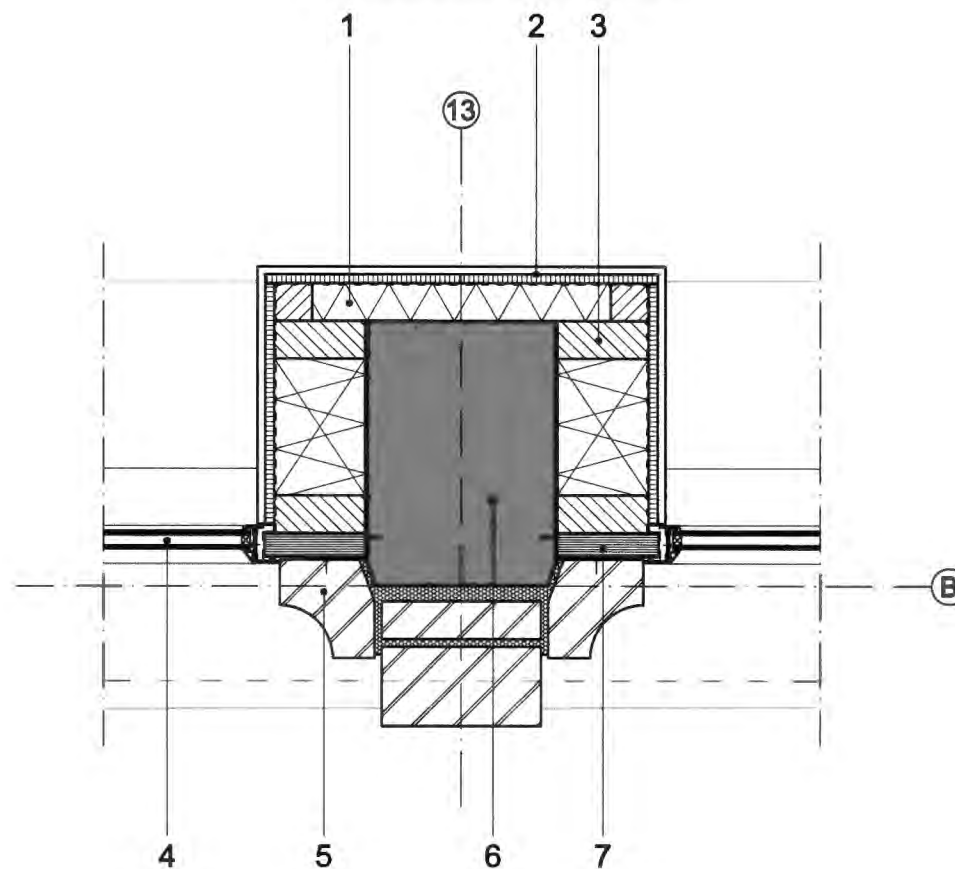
GEVELKOLOM BEGANE GROND EN 1<sup>E</sup> VERDIEPING
